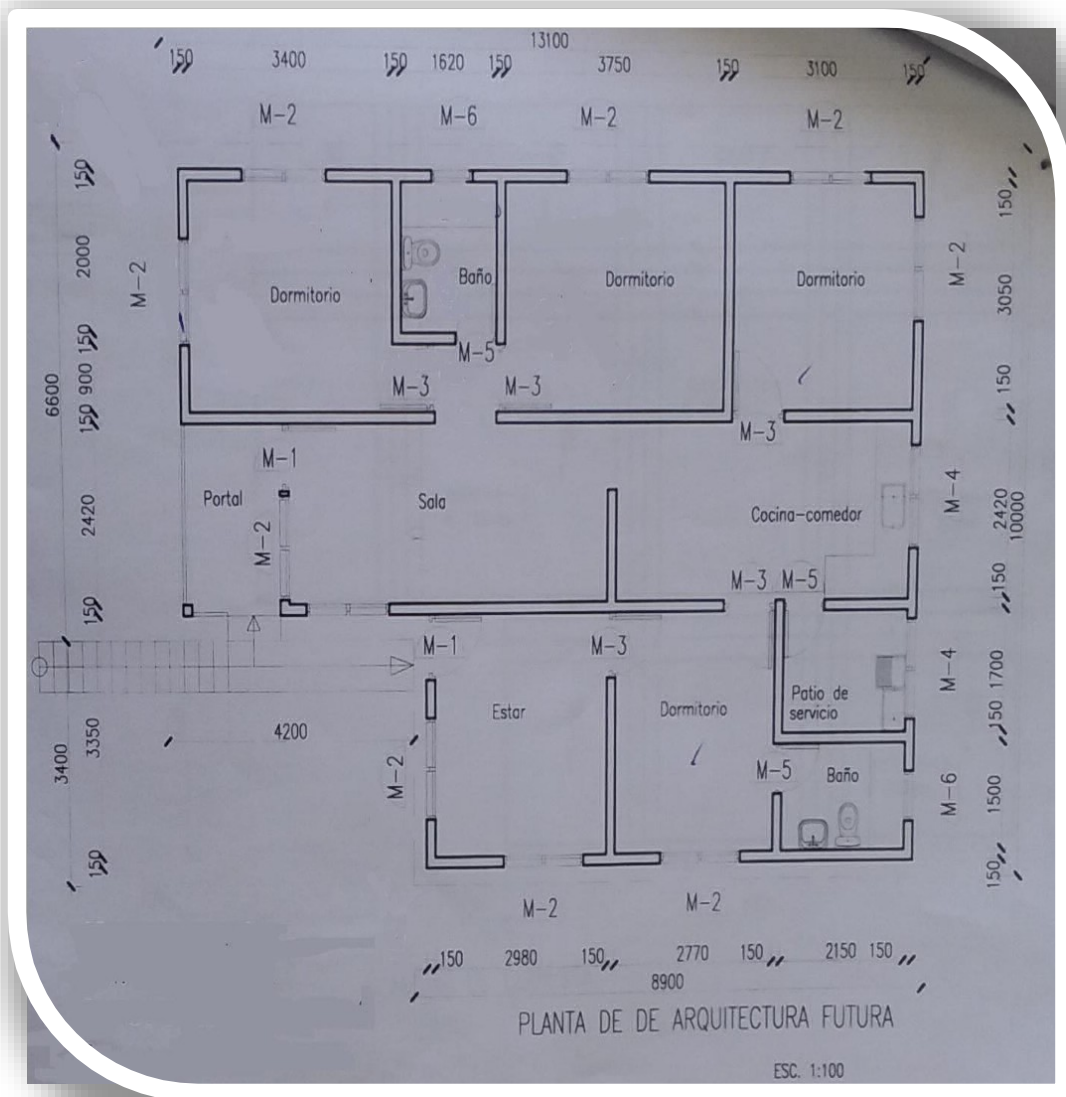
Modelo de la Vivienda. Plano de Planta. Fuente: Modelos de Viviendas del Arquitecto de la Comunidad del Municipio Cienfuegos.
